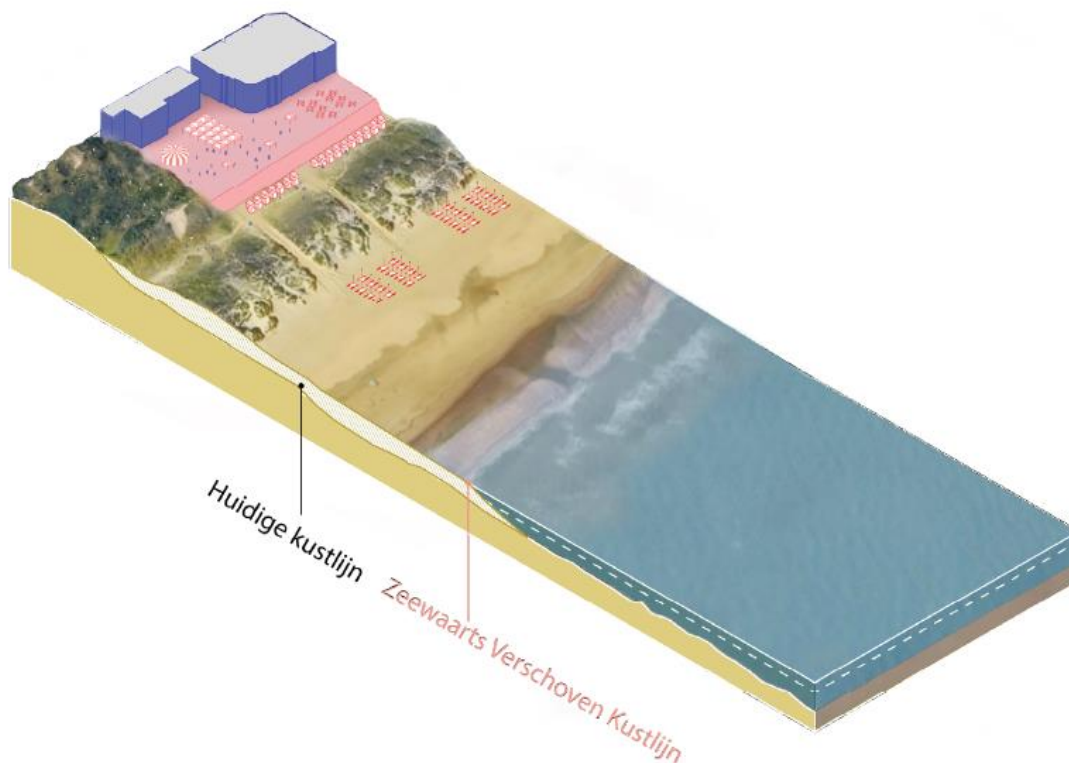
Voorbeelduitwerking van de graduele ophoging van de zeewering en het strand bij de invulling van het kustbeschermingslint ter hoogte van de badplaatsen voor het alternatief "ter plaatse".
